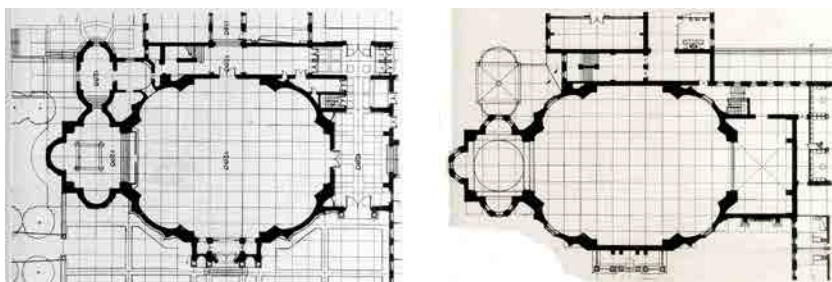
y Fig. 21 Planta baja (izquierda) y planta alta (derecha) de la iglesia de la Universidad Laboral de Zamora.
